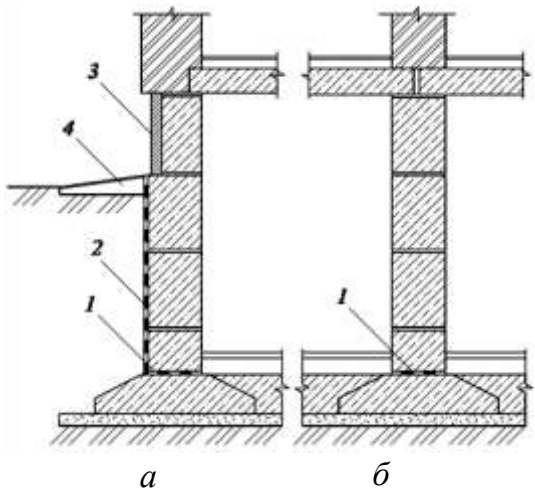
Гідроізоляція збірних фундаментів будівель з підвалами в сухих ґрунтах:
